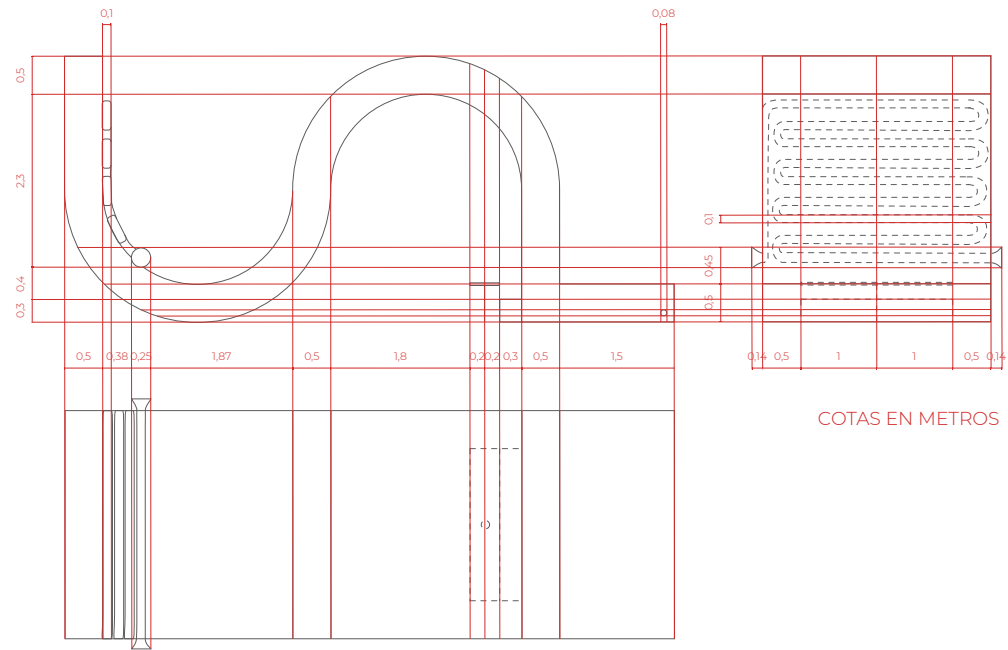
Dibujo Constructivo IV. Estructura verde, elaboración propia.
